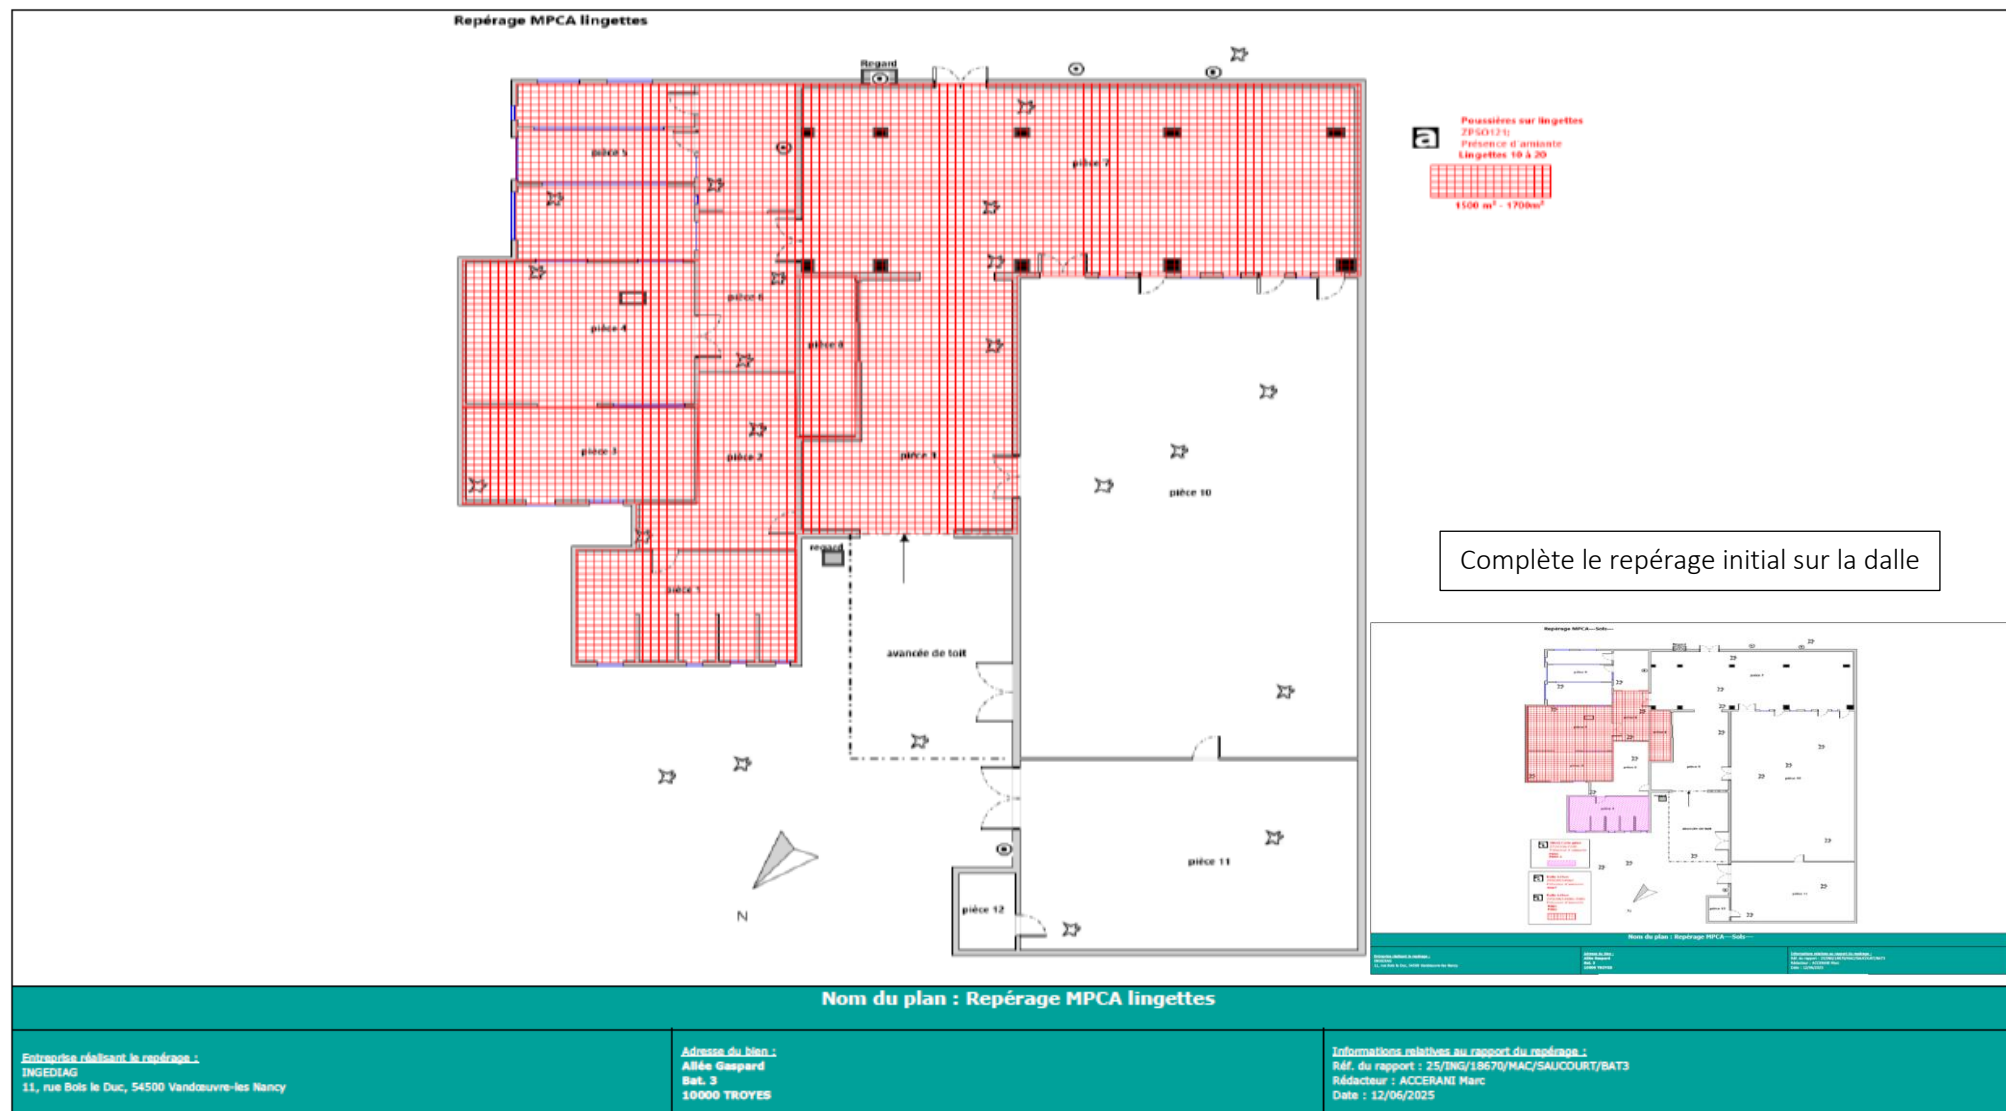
Plan des prélèvements au niveau des dalles surfaciques contenant de l'amiante dans le bâtiment 3
